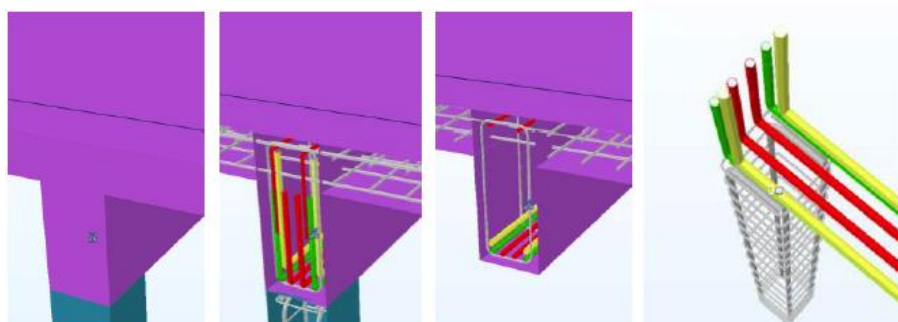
Modelo de viga de betão armado para apoio ao ensino em ‘Estruturas de Betão I’
